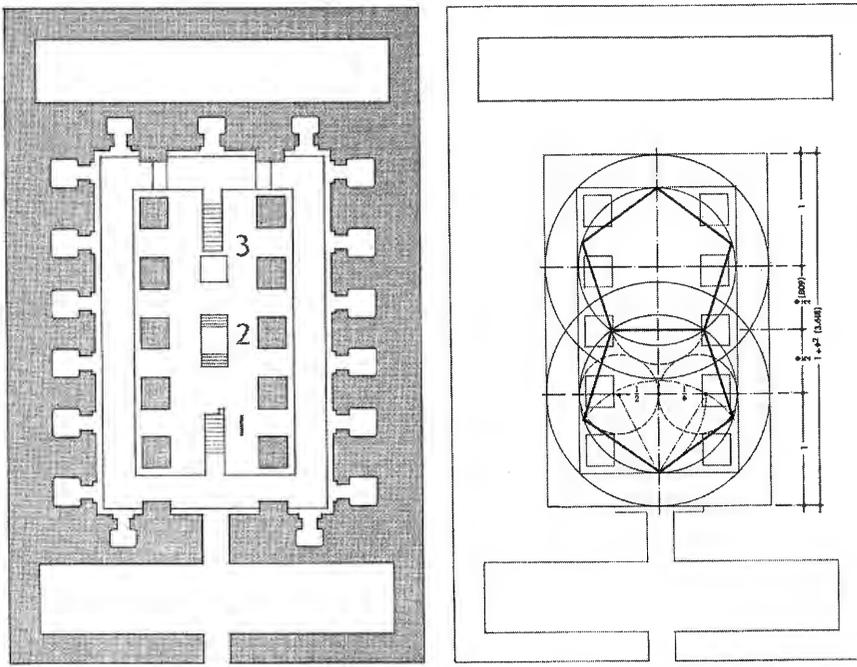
Grundriss des zweiten Osiristem-
